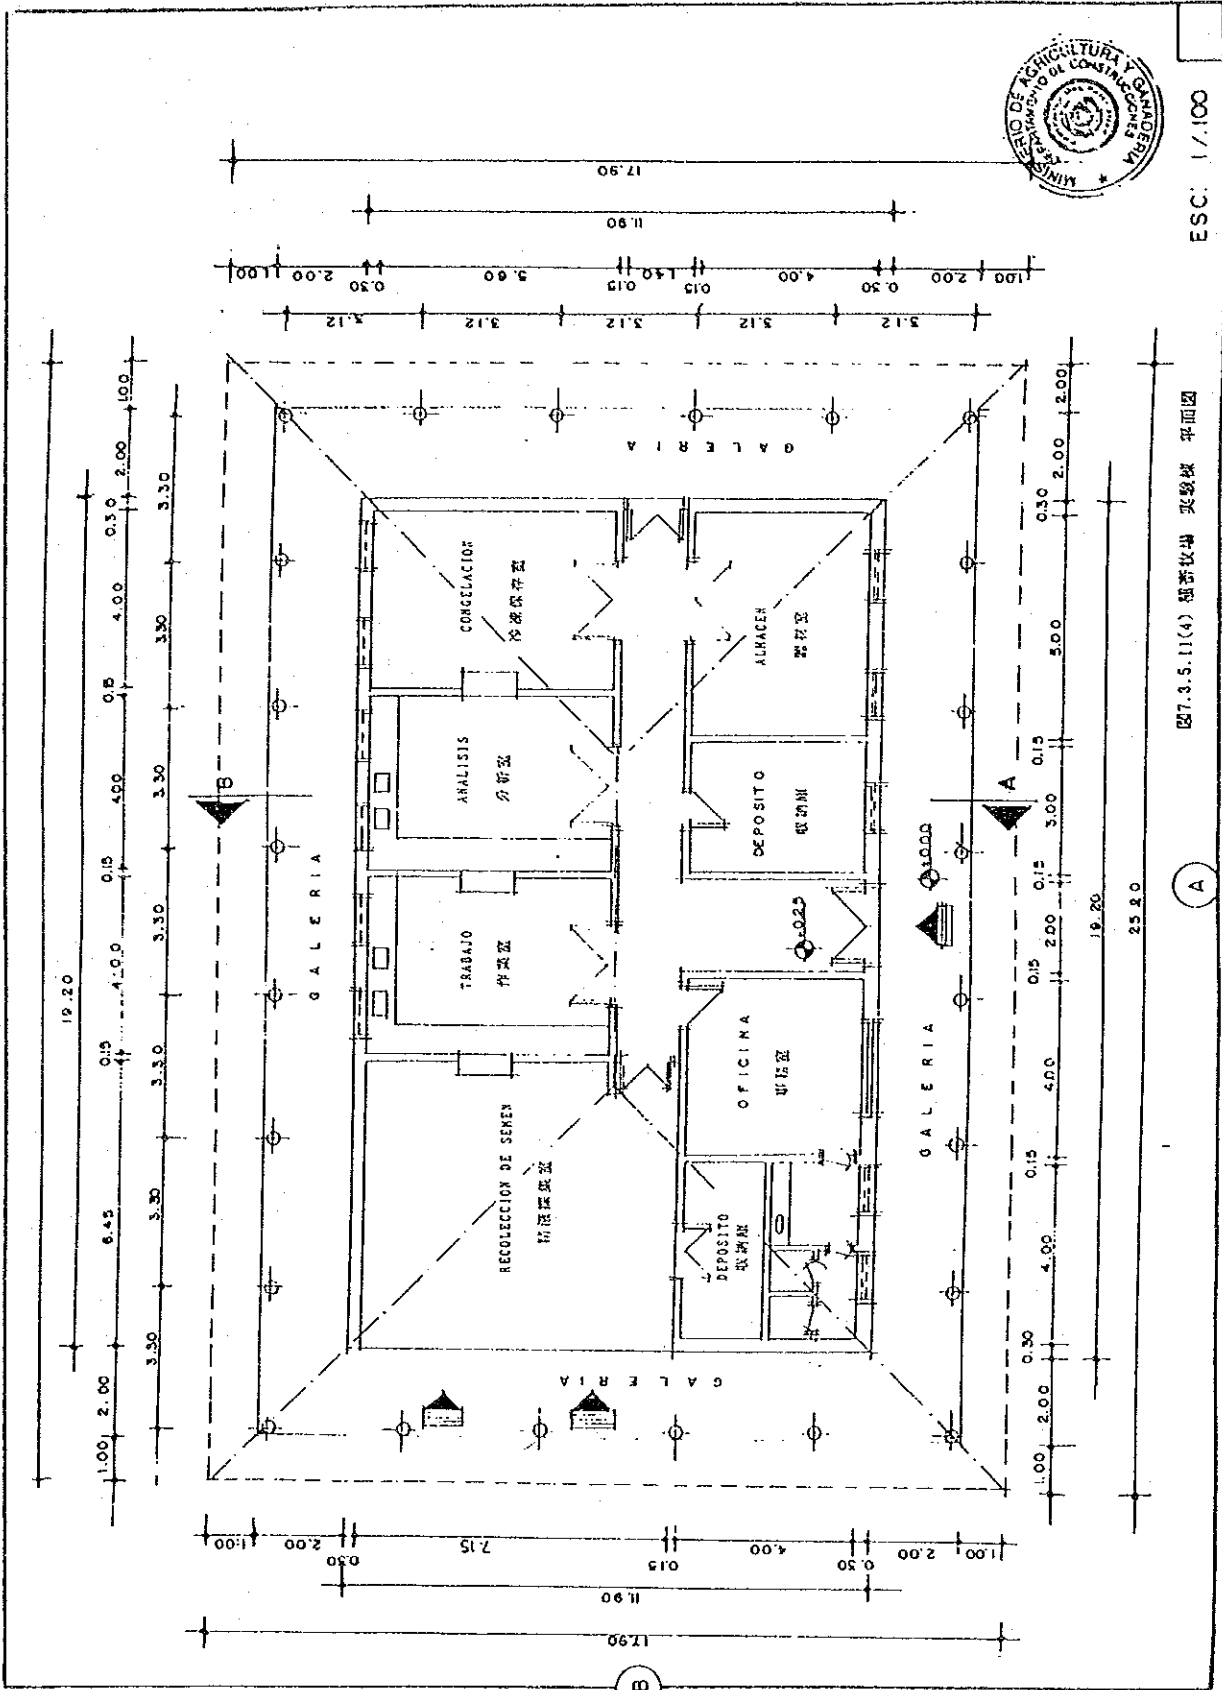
(4) 烟草牧場 実験棟 平面圖
